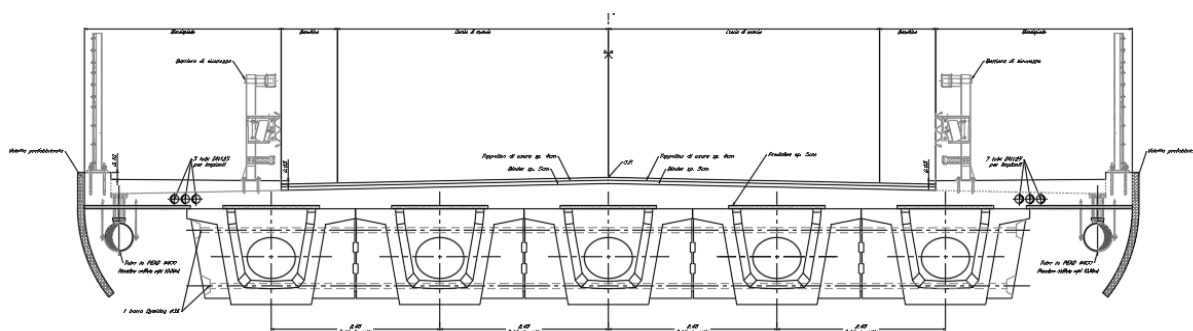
Cavalcaferrovia di via Wenner – Sezione trasversale impalcato
